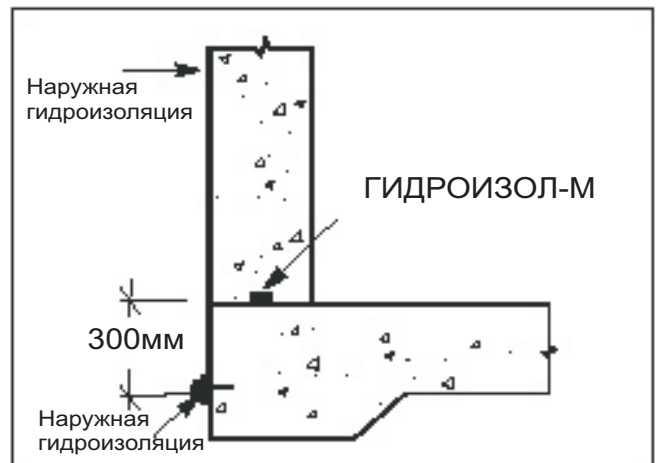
Монтаж шнура на стыках основания и фундаментной стены
